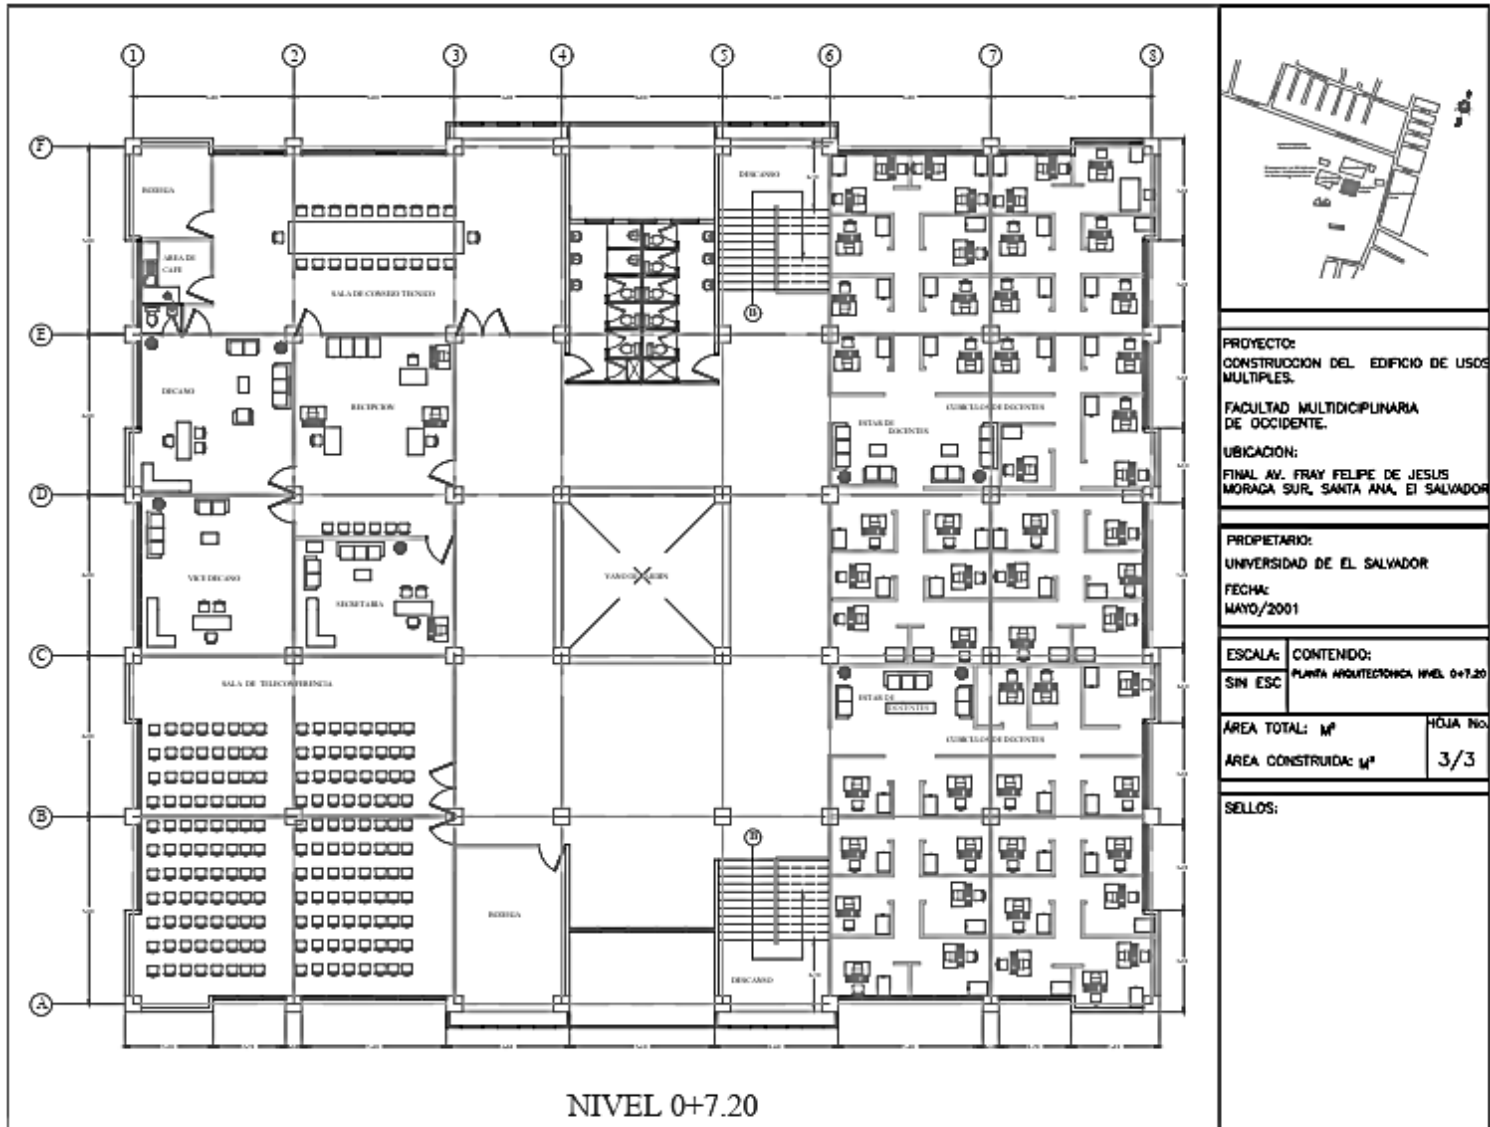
Planta Arquitectónica Nivel 0+7.20 del edificio en evaluación
